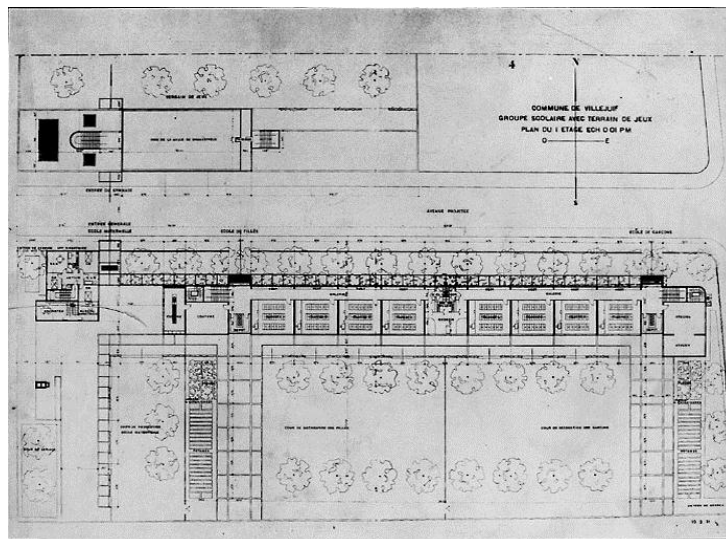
Planta do primeiro piso do *Groupe Scolaire Karl Marx*.
